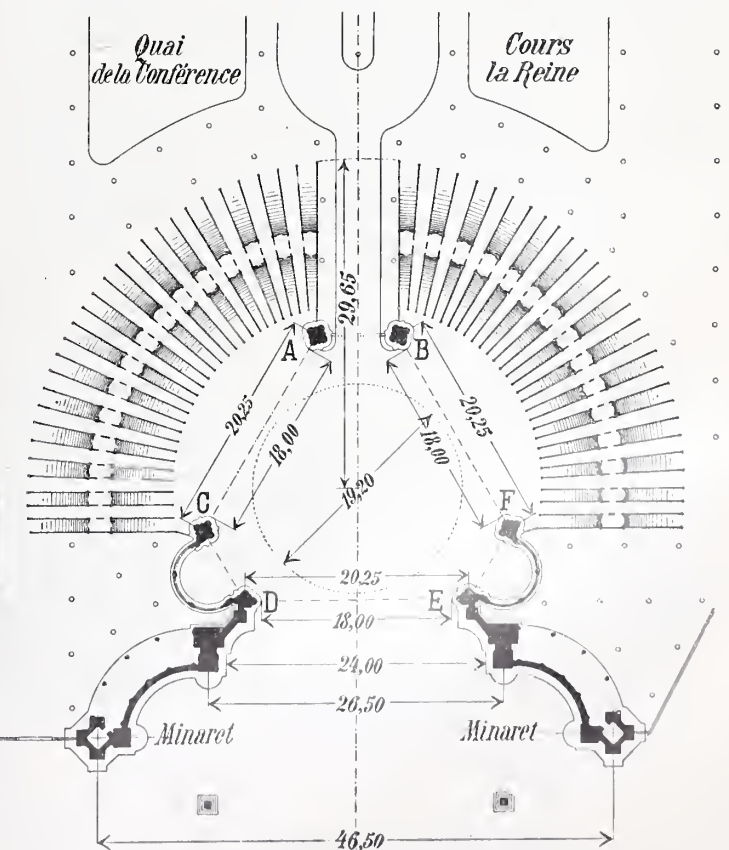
Grundriss der Haupteingangshalle. 1:720.
